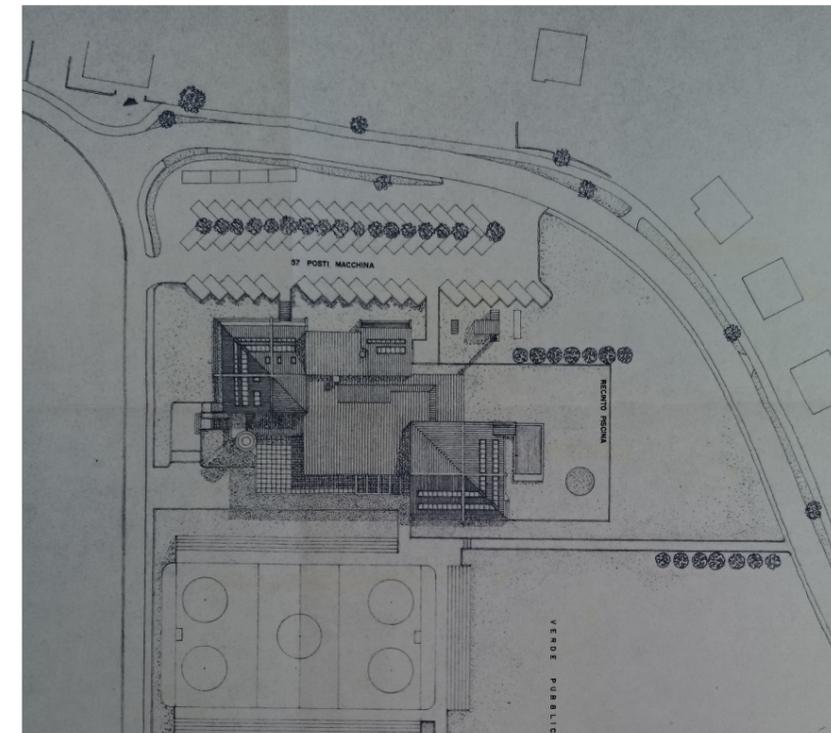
Hallenbad St. Vigil, Lageplan von 1979
